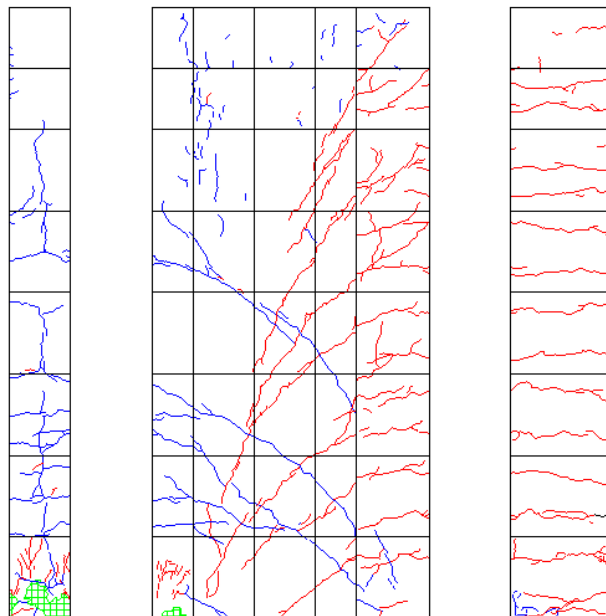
R=-1/50 ひび割れ図
